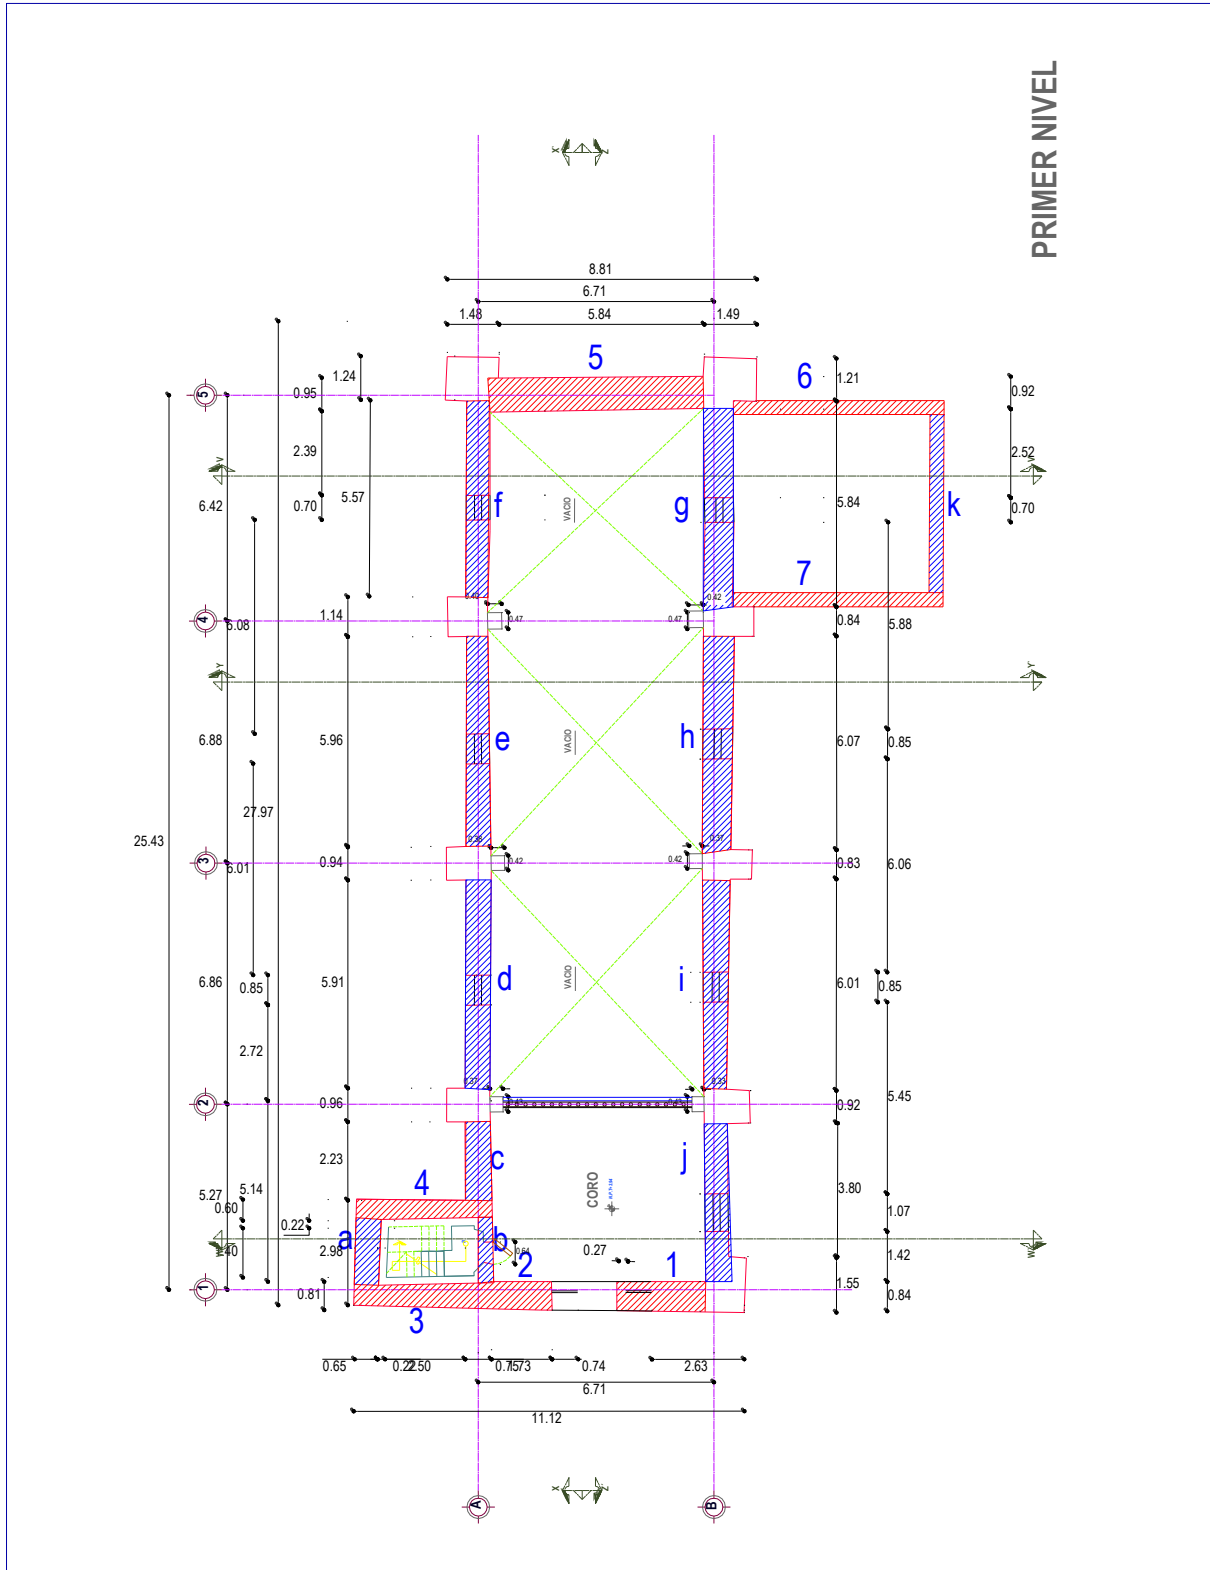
Esquema de plano arquitectónico 1 (Gutiérrez, 2011)
